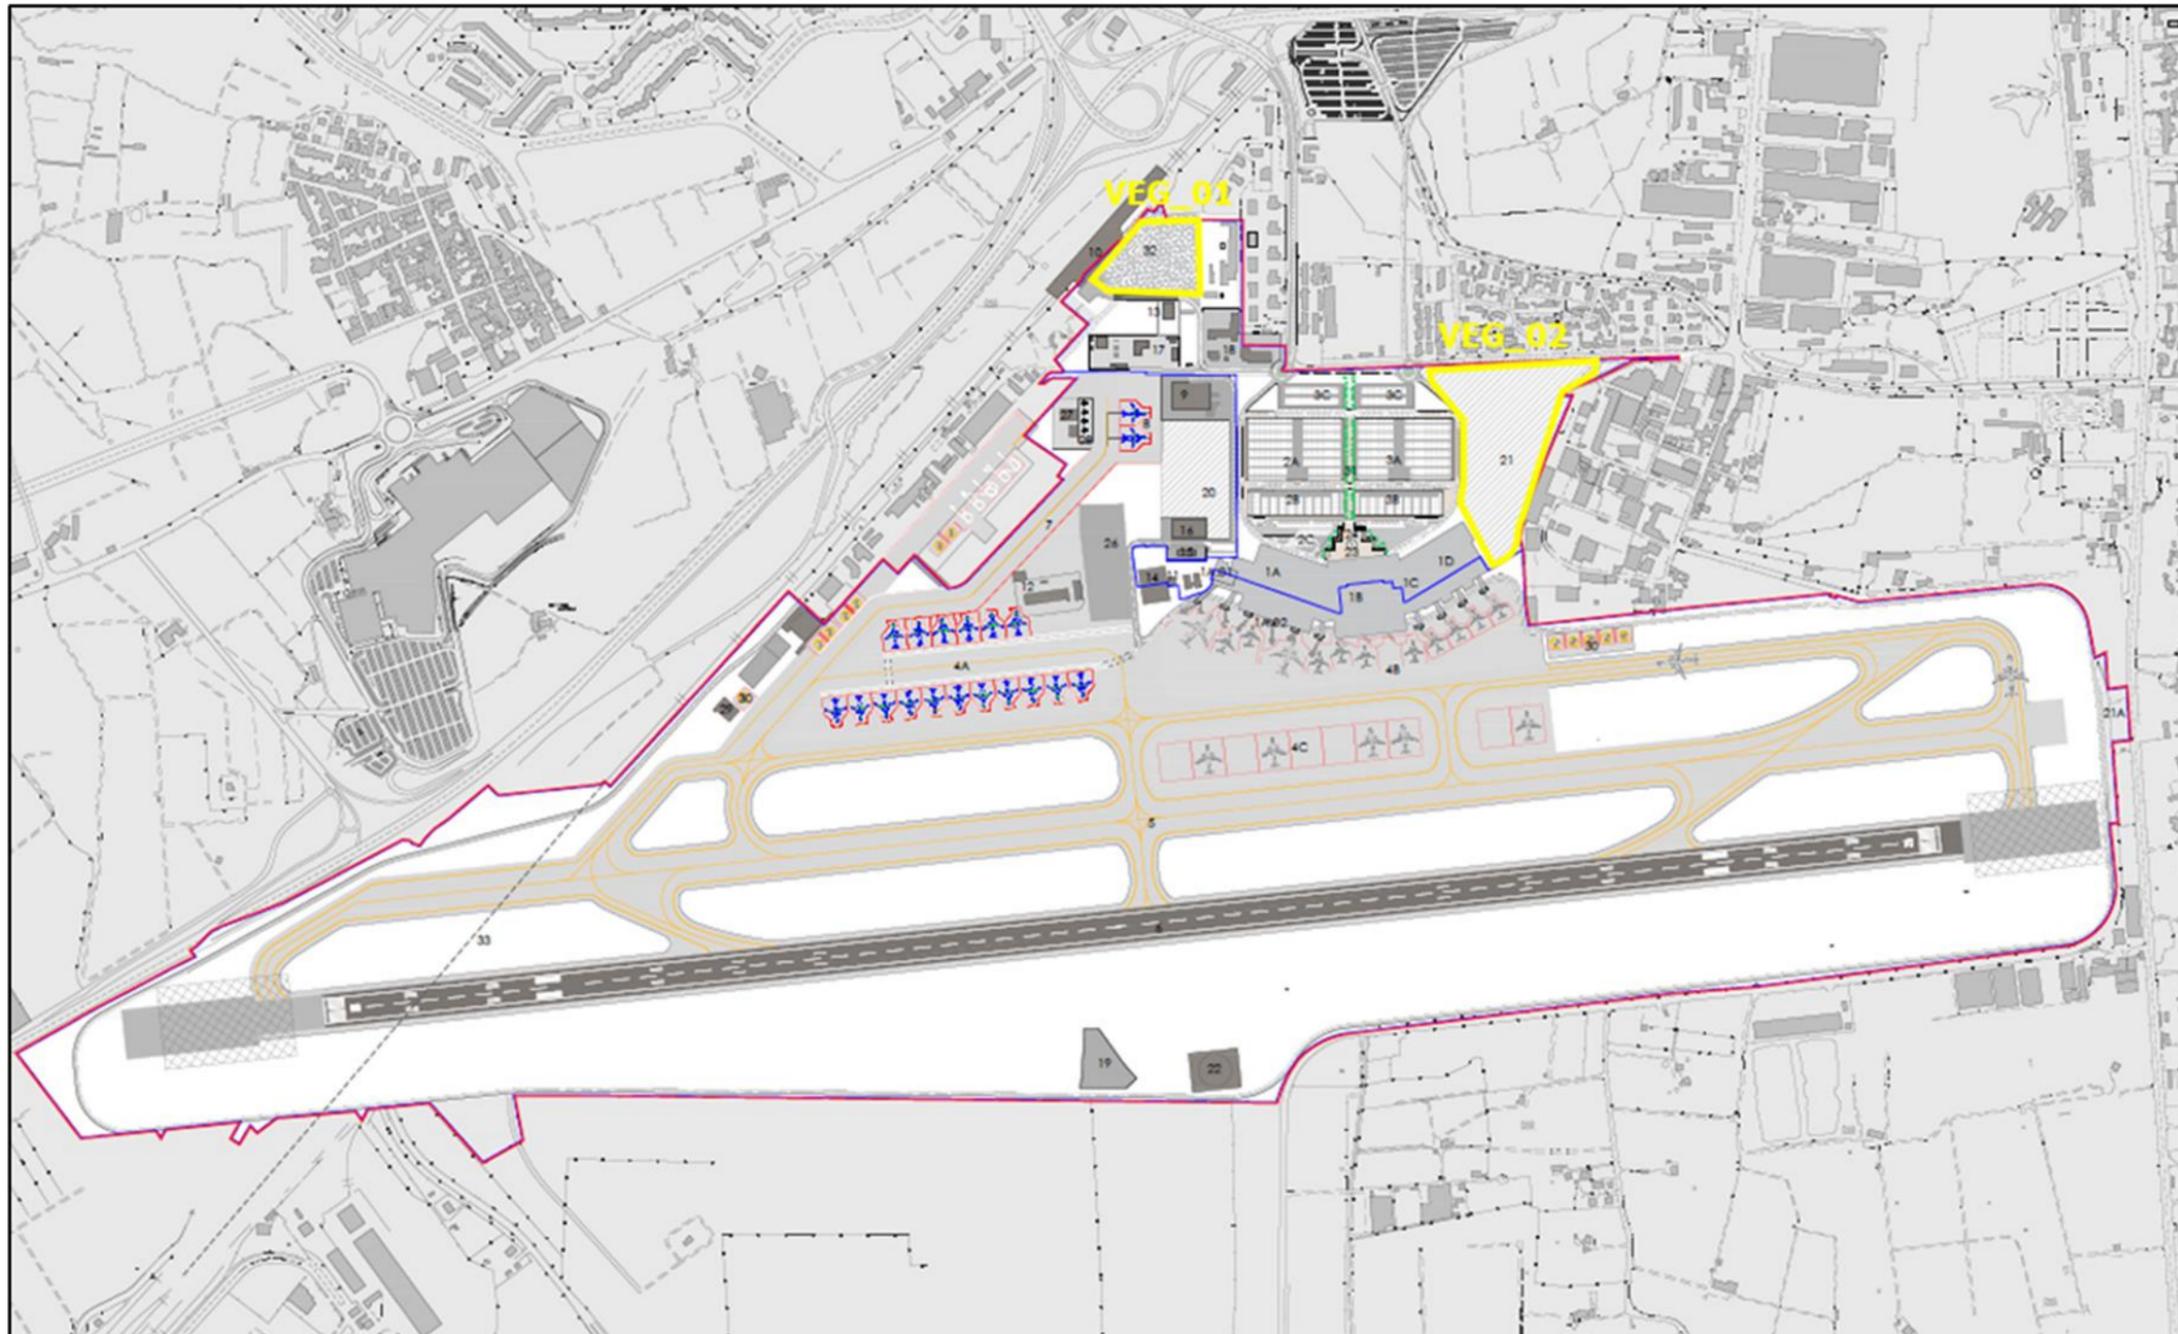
Vegetazione: Planimetria di ubicazione delle aree monitoraggio - Localizzazione su Masterplan
